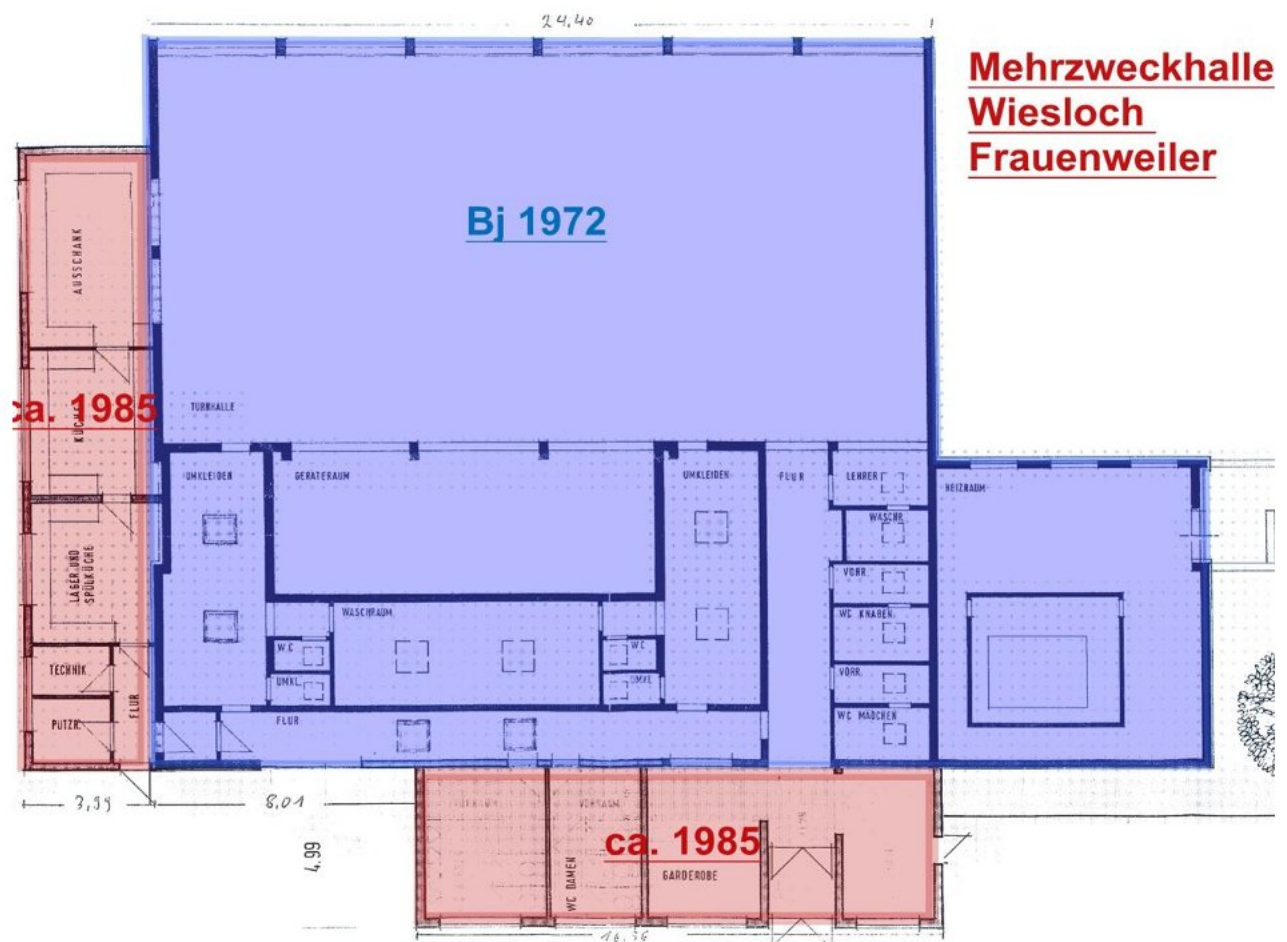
Nicht maßstäblicher Grundriss der Mehrzweckhalle und angrenzender Räume.
